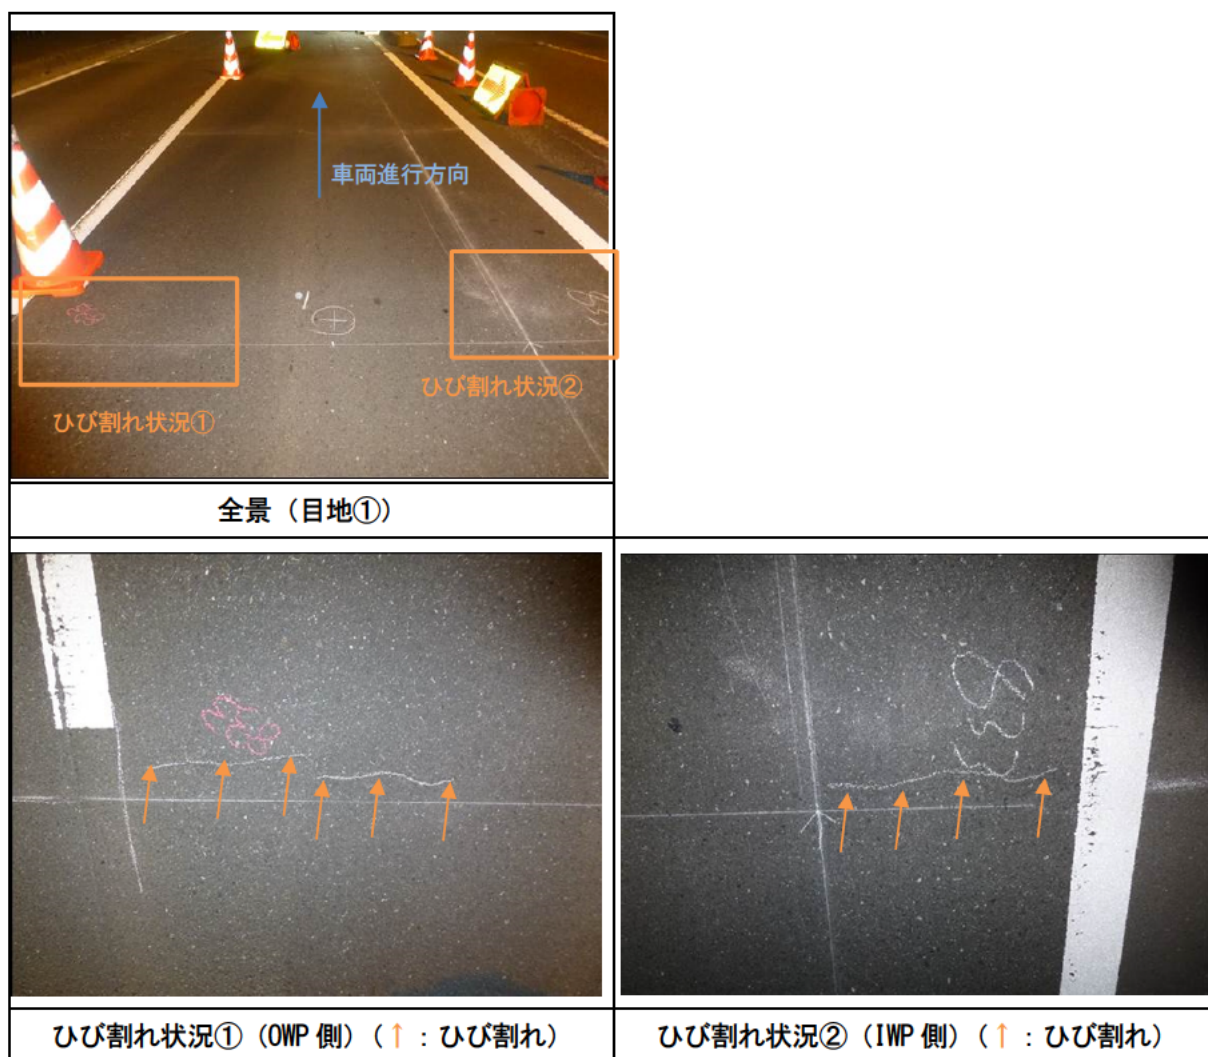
ひび割れの様子 (目地①)
